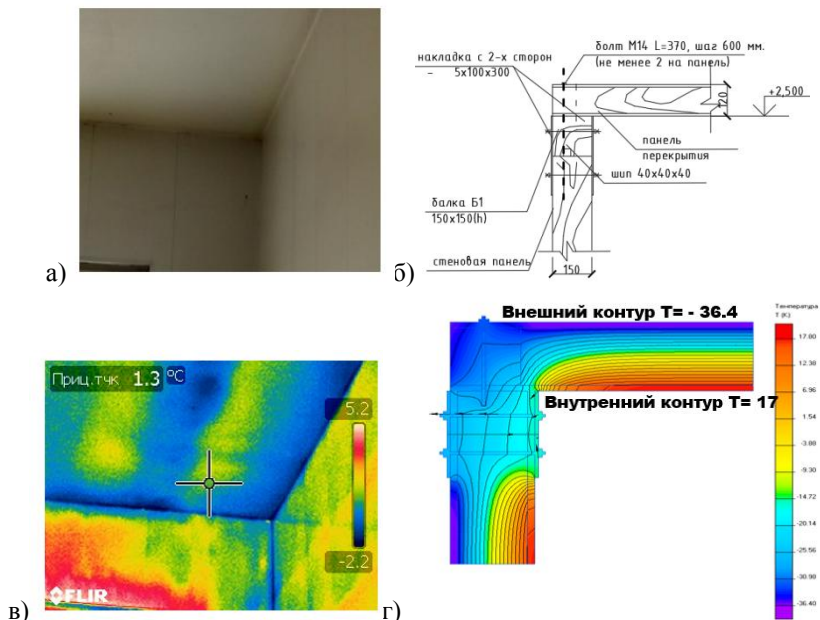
Узел соединения стеновых панелей на углах между собой а) фото угла; б) конструктивный узел; в) тепловизионная съемка; г) расчет в программе Elcut 6.3
